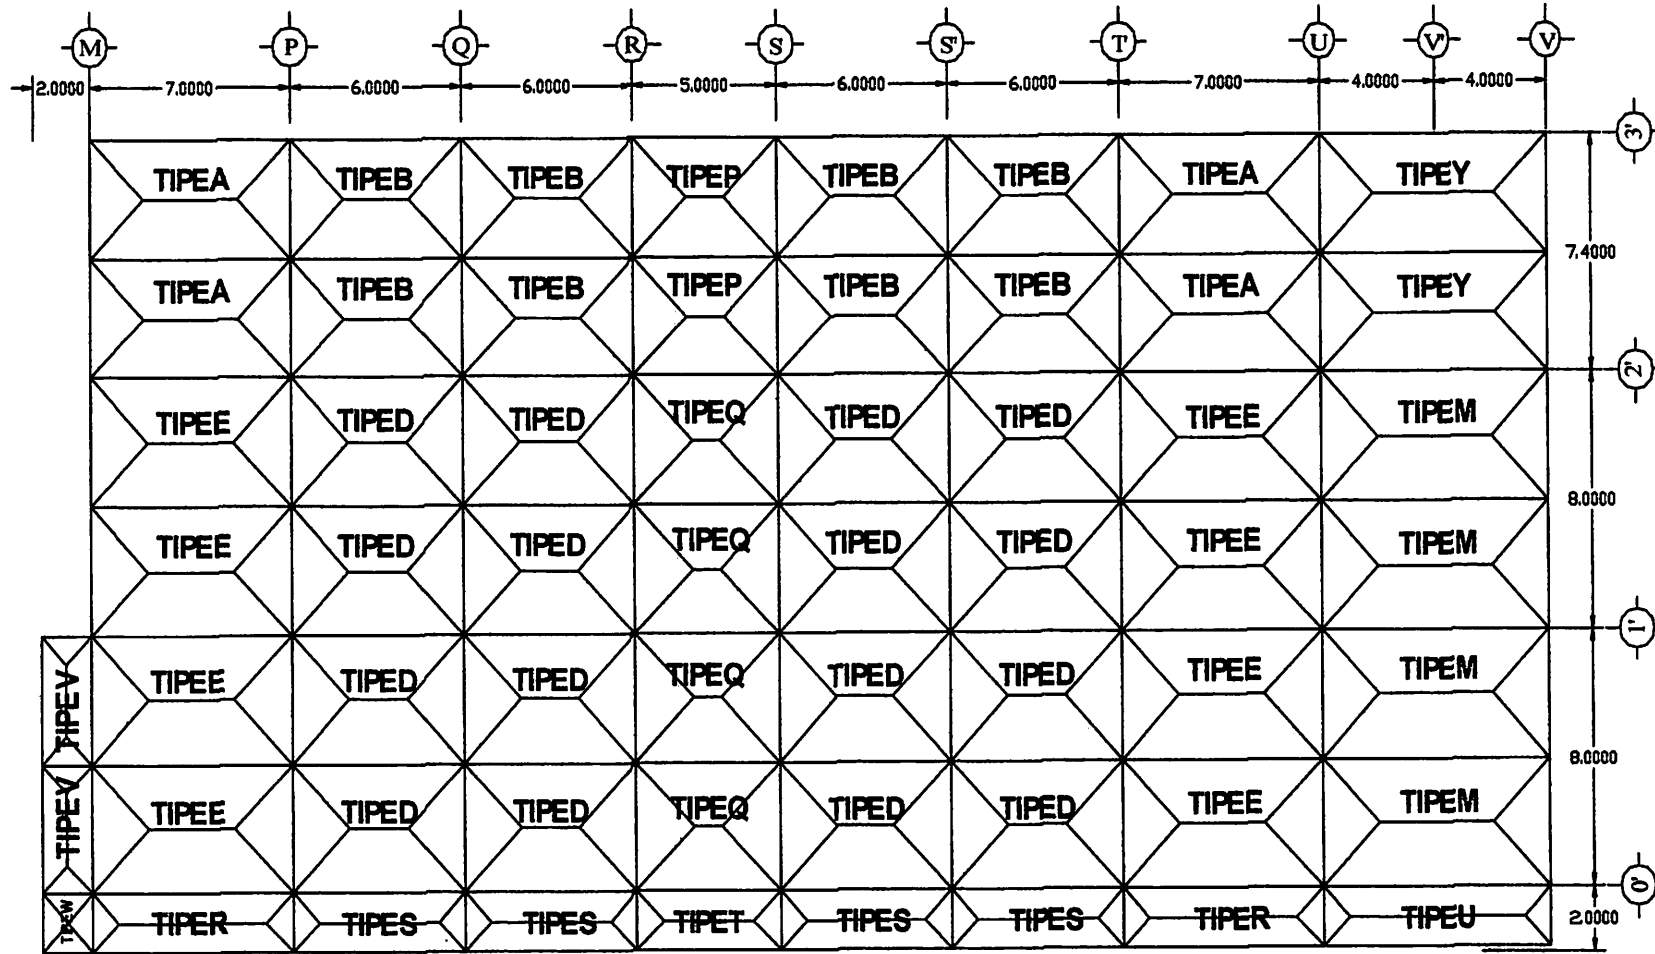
Denah Pelat Lantai 1A Pertokoan
